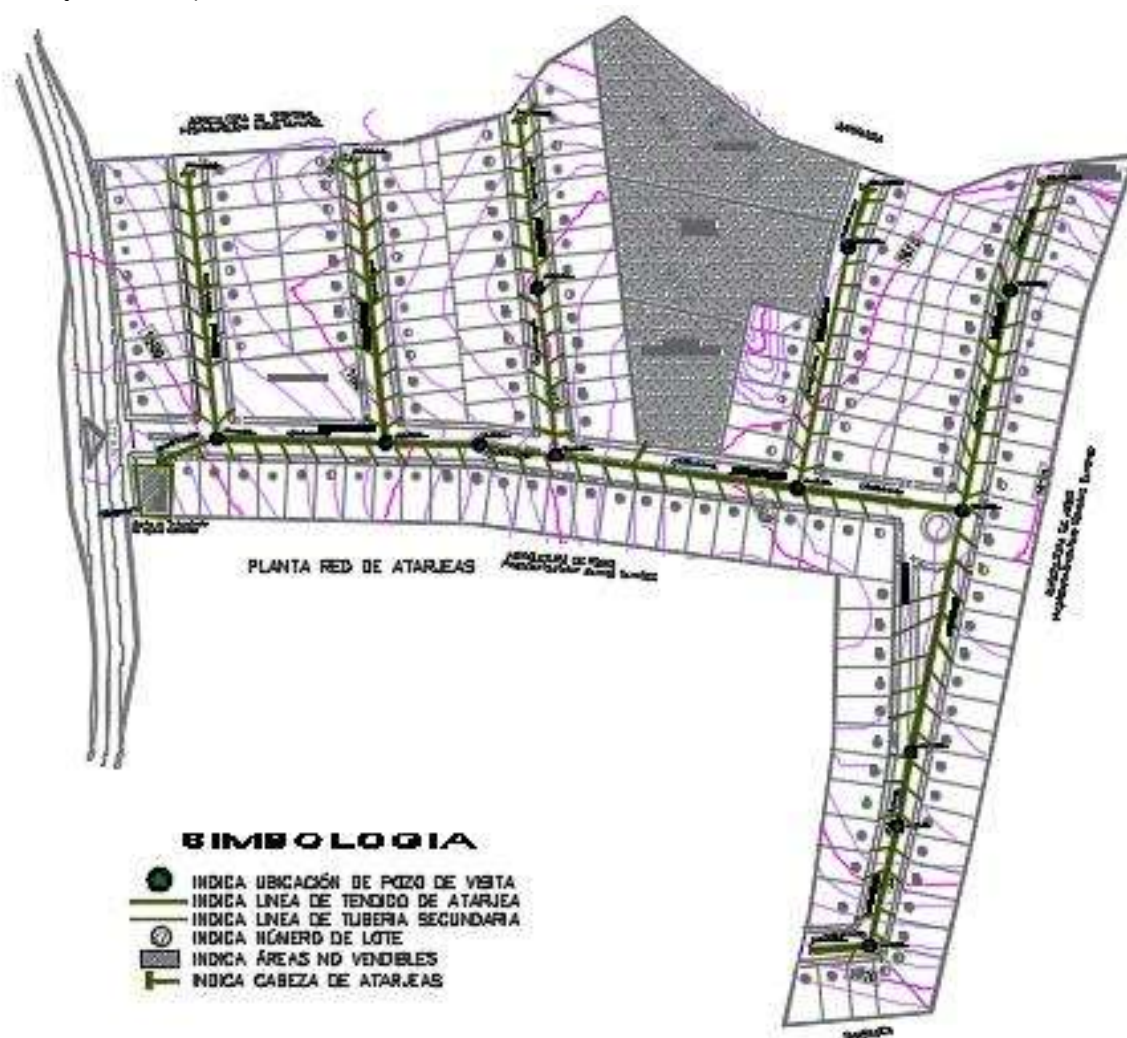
Red de alcantarillado sanitario, extraído del plano de instalación sanitaria, ver más detalles en Plano anexo DESHAB_SANIT_06
